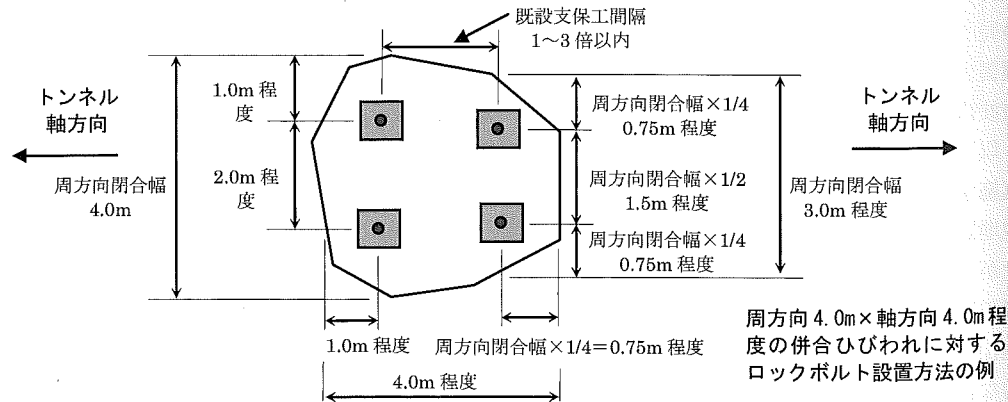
閉合ひび割れに対するロックボルト設置の考え方の例
